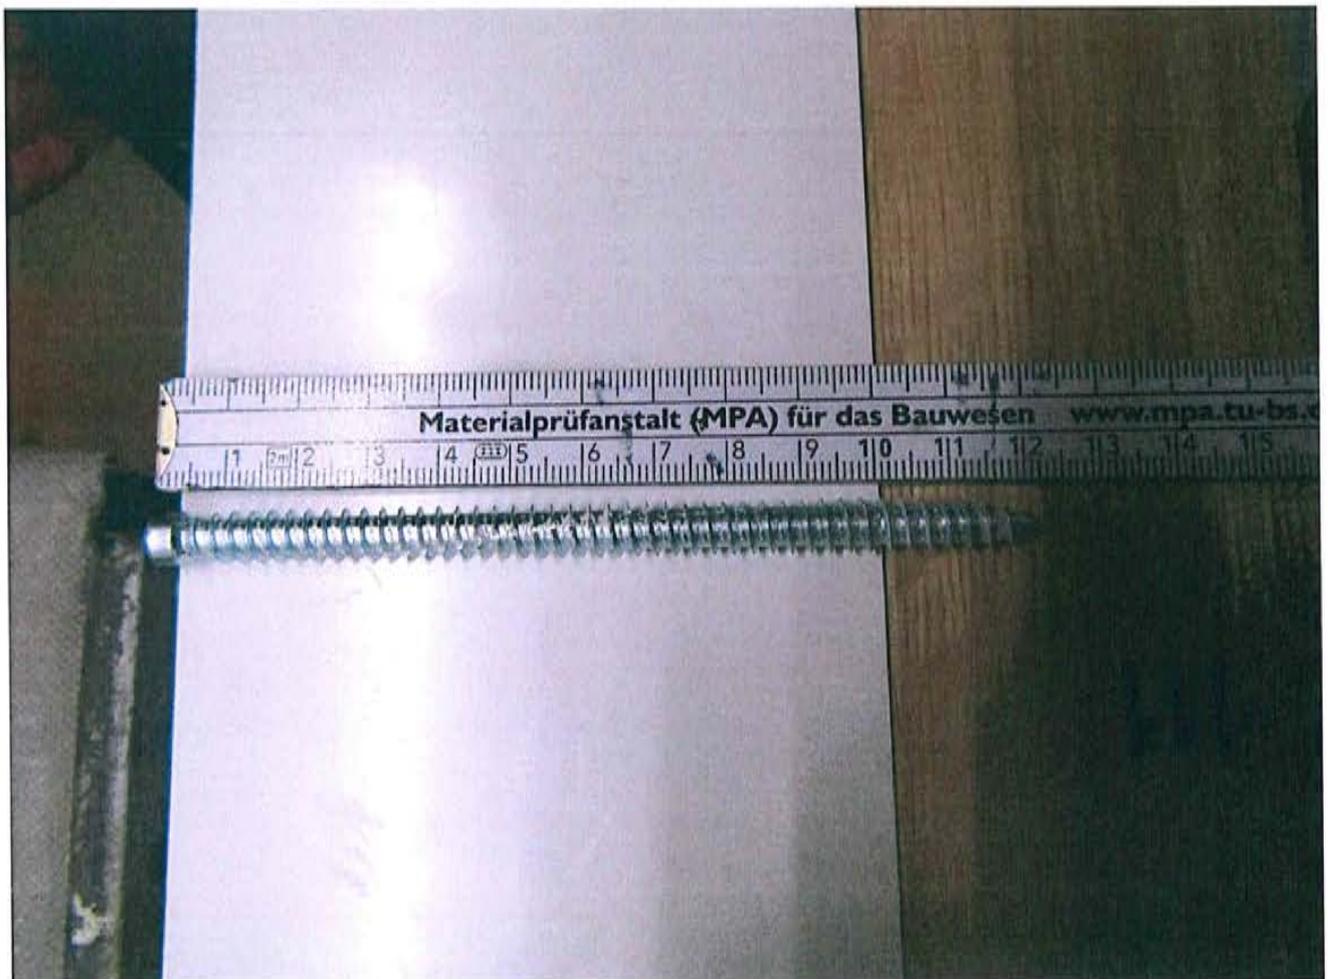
Das Holzprofil ist mit vier blaugelb Rahmenfixschrauben ZK-T30, $\varnothing 7,5$ $l = 122$ mm, an dem SDP befestigt
